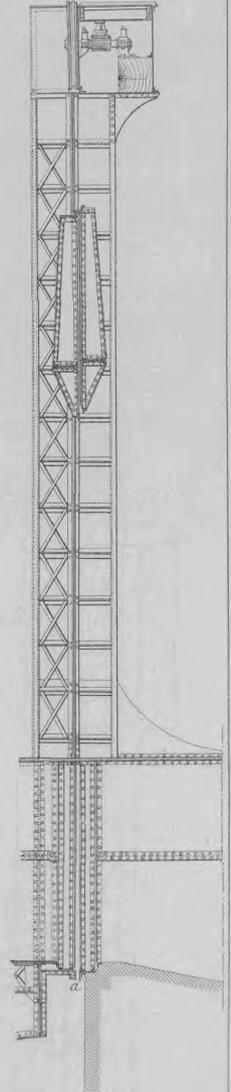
Coupe latérale dans les enclaves. Echelle 1/20
